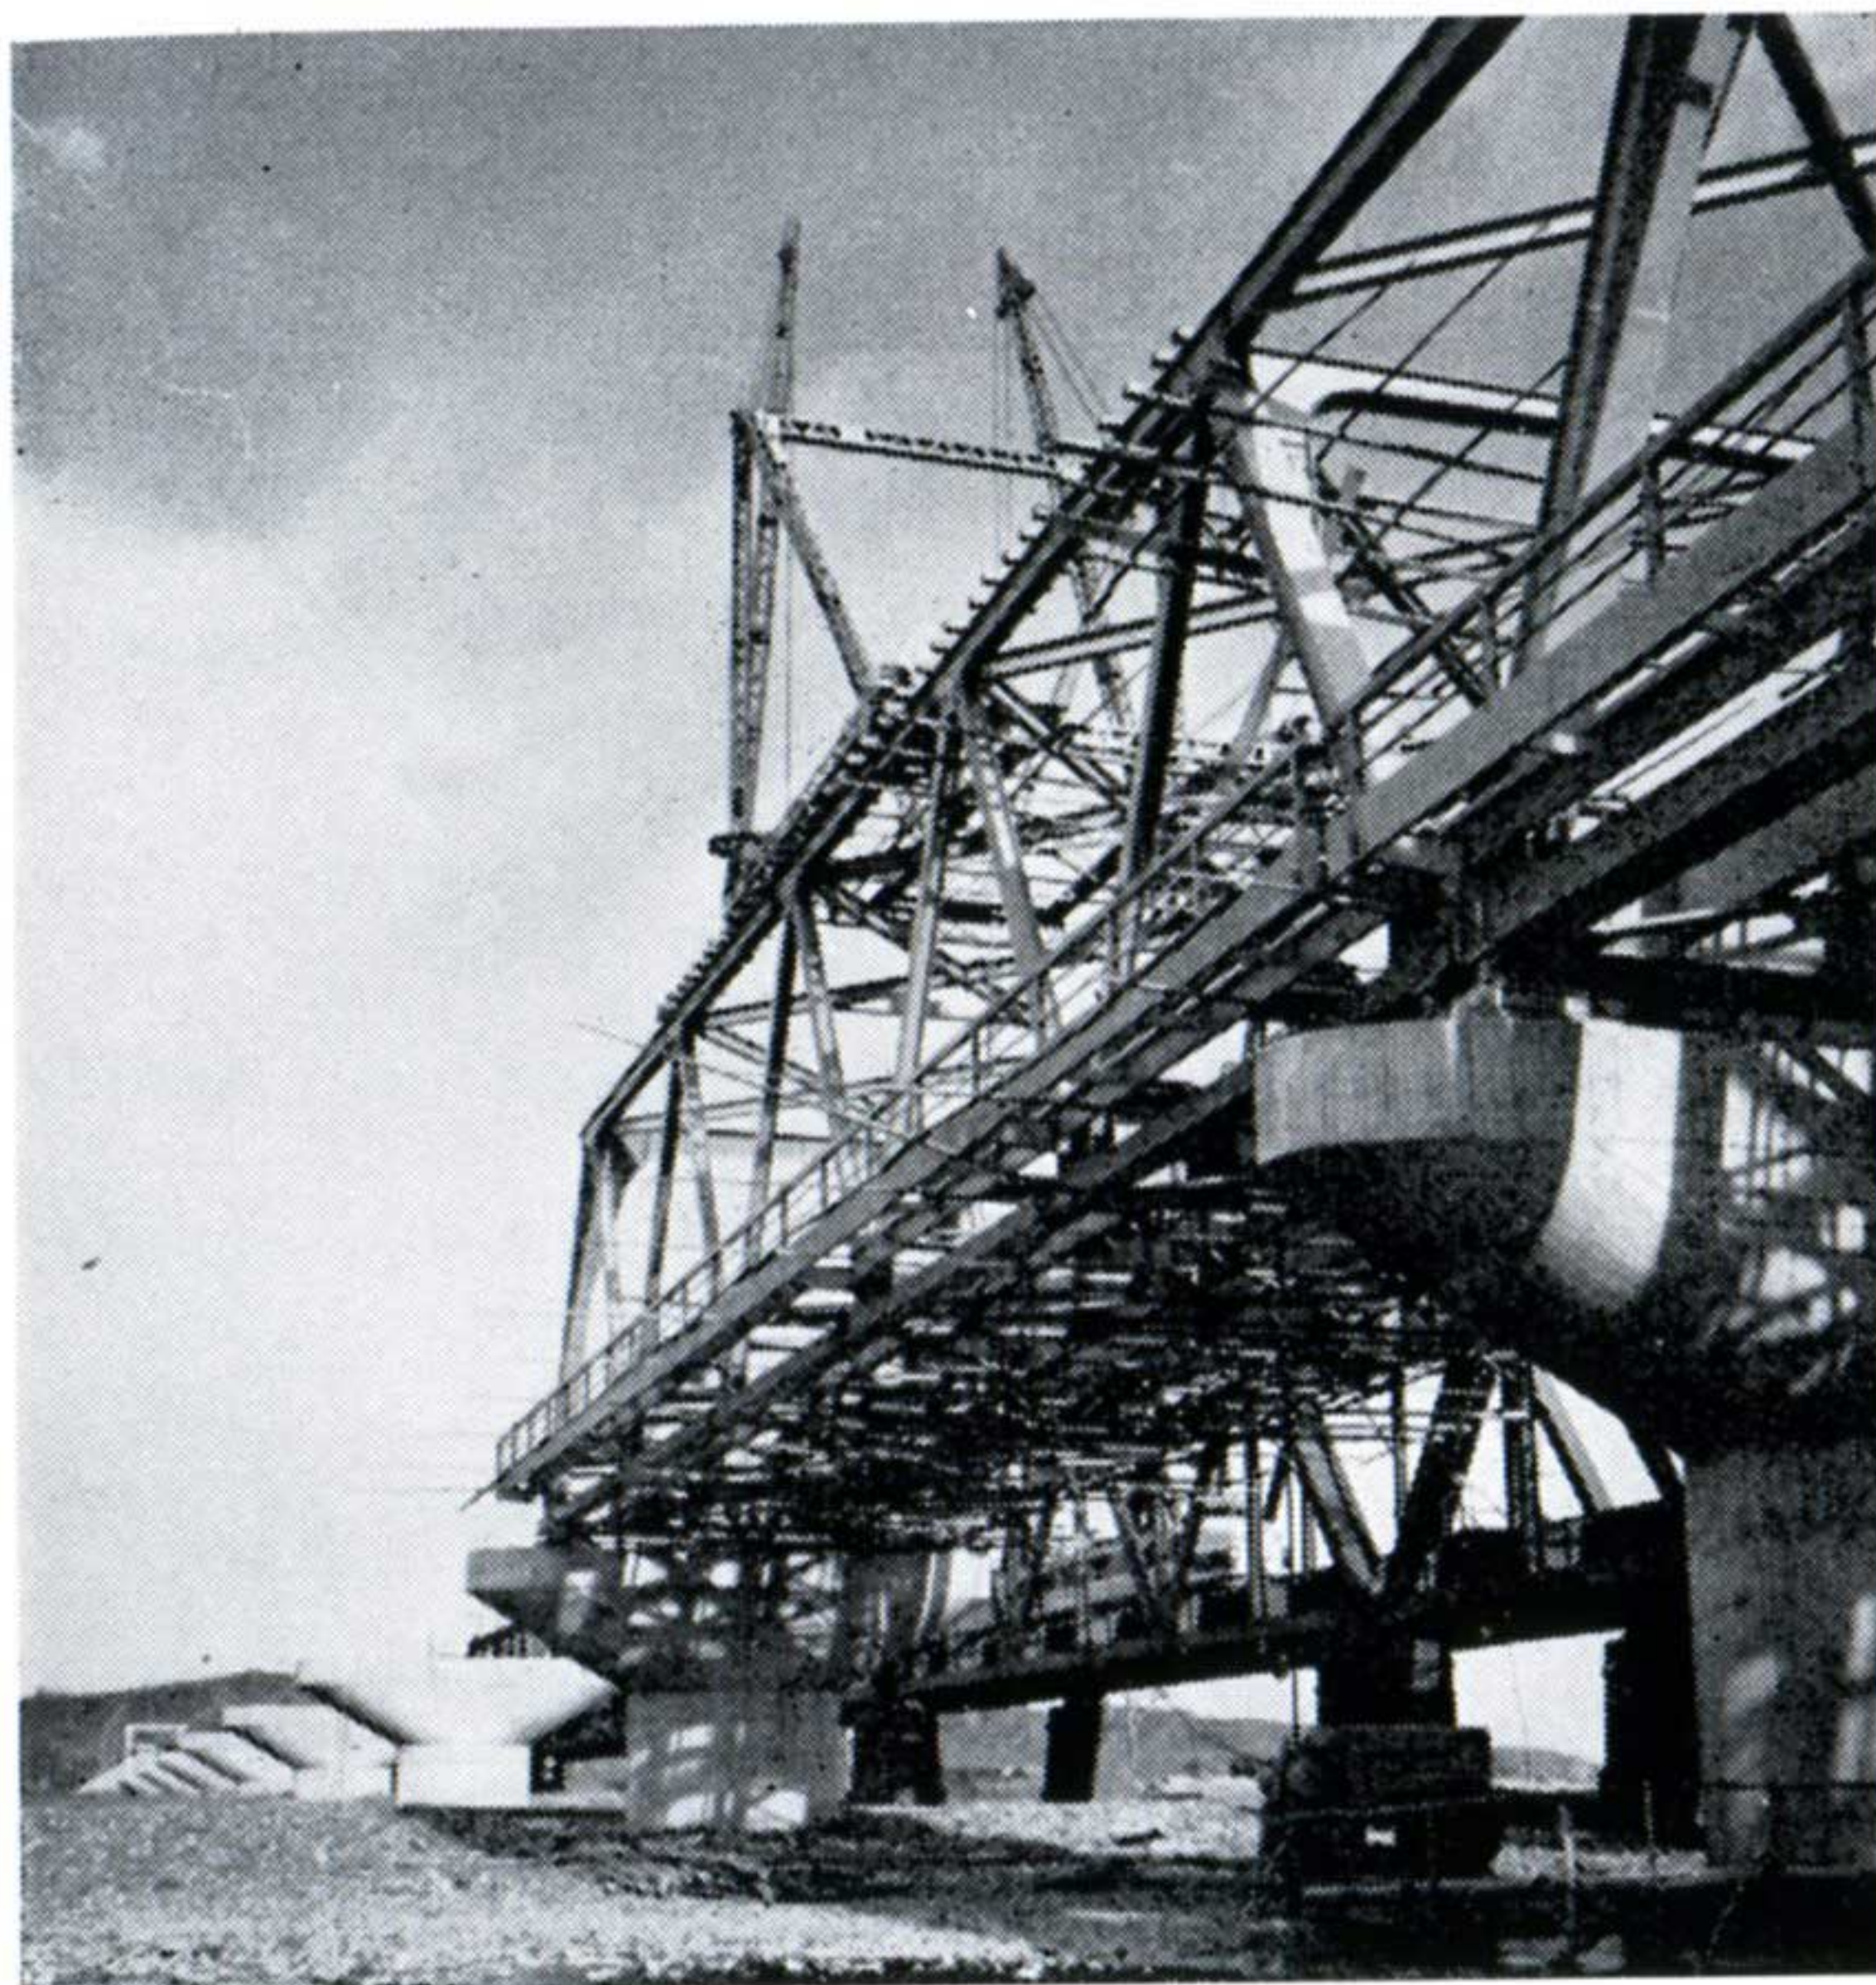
Travaux de construction du pont de Soka-wagawa, près d'Odawa, en juillet 1961.
